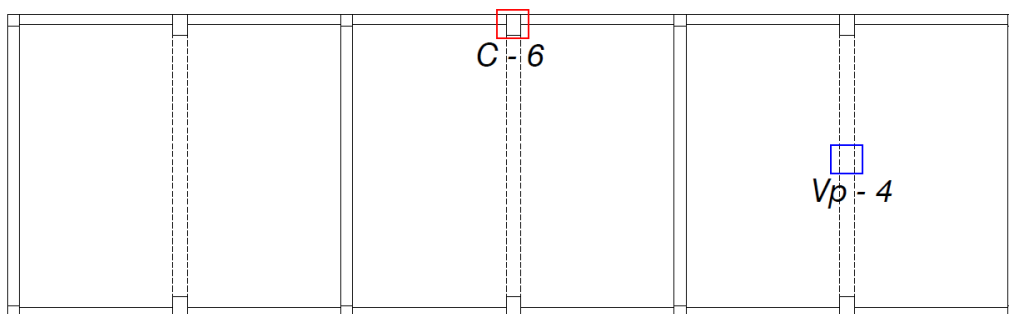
Ubicación de ensayo de Esclerómetro en el pabellón 3 – 2do piso
